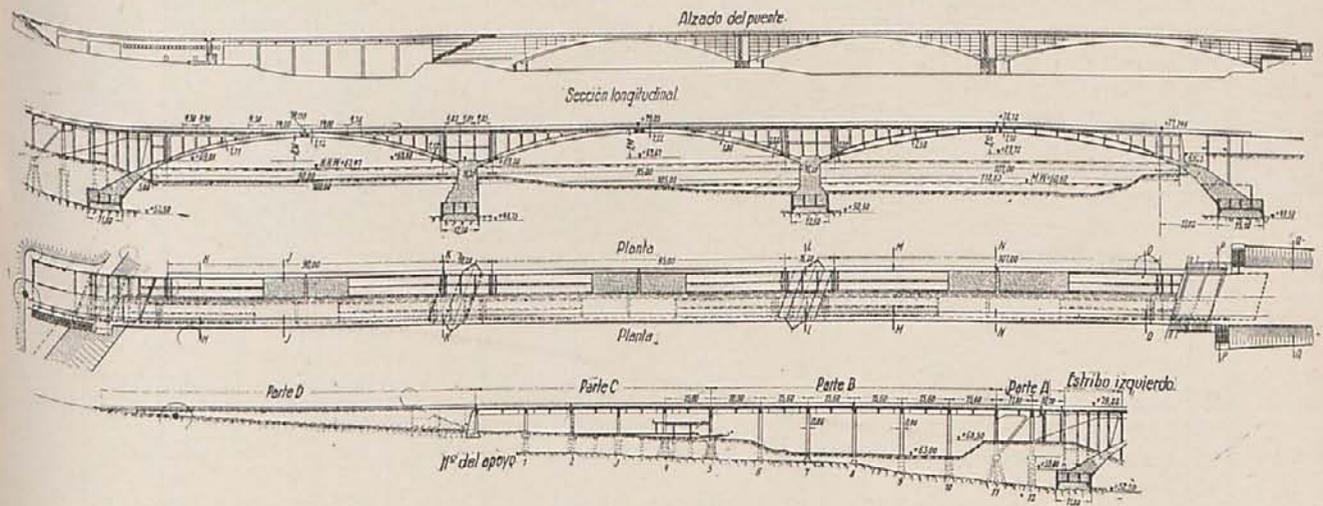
Alzado, sección longitudinal, planta y alzado de la palizada.
